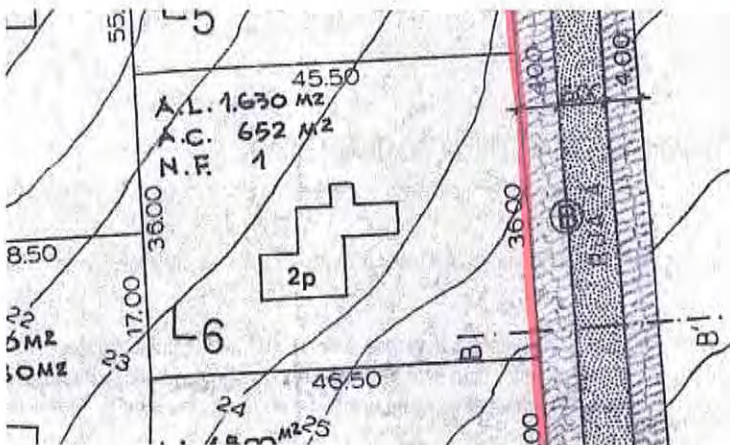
Planta do Loteamento com aproximação ao Lote da Proposta
